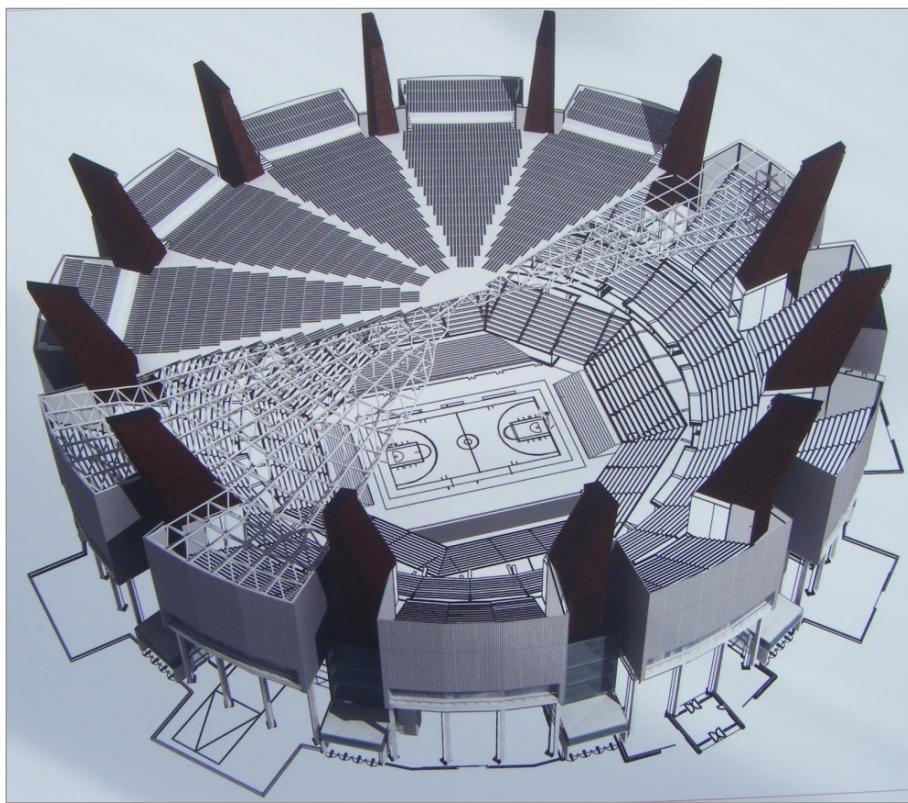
Pabellón multiusos Fernando Buesa Arena. Fuente: Servicio de Secretaría Técnica de Arquitectura de la Diputación Foral de Álava (2010)
